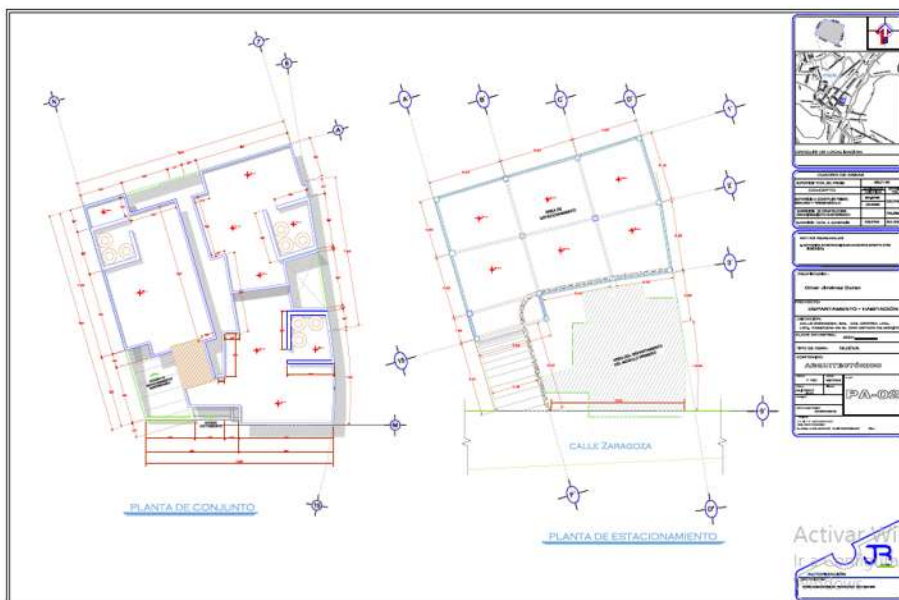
Imagen del plano resultante de vista de Azoteas, así como el despliegue de la distribución de columnas del Estacionamiento Subterráneo, con su respectiva rampa de acceso. También se representa un achurado de la planta del módulo uno, del desplante de los primeros departamentos frontales que colinden con la calle de acceso (Calle Zaragoza).
